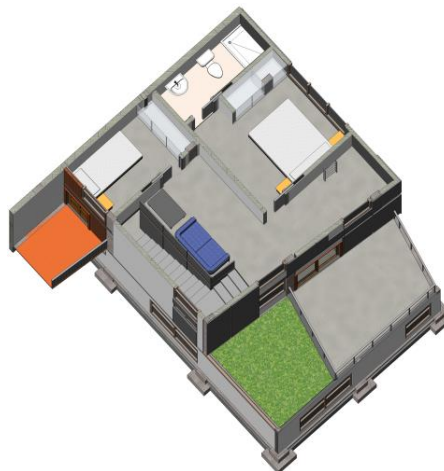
Vista 3d. Tipología 2 Nivel 2. Fuente: Propia
